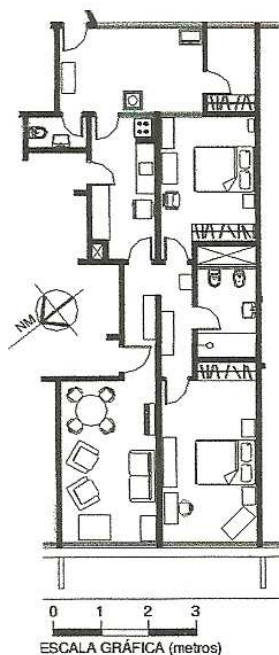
Planta baixa de apartamento do bloco A (Fonte: GALVÃO e ORNSTEIN, 2008, p.5)
